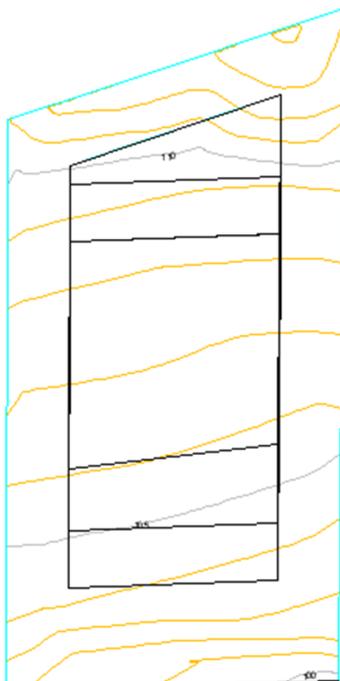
Levantamiento topográfico del terreno en donde se planea construir el edificio
